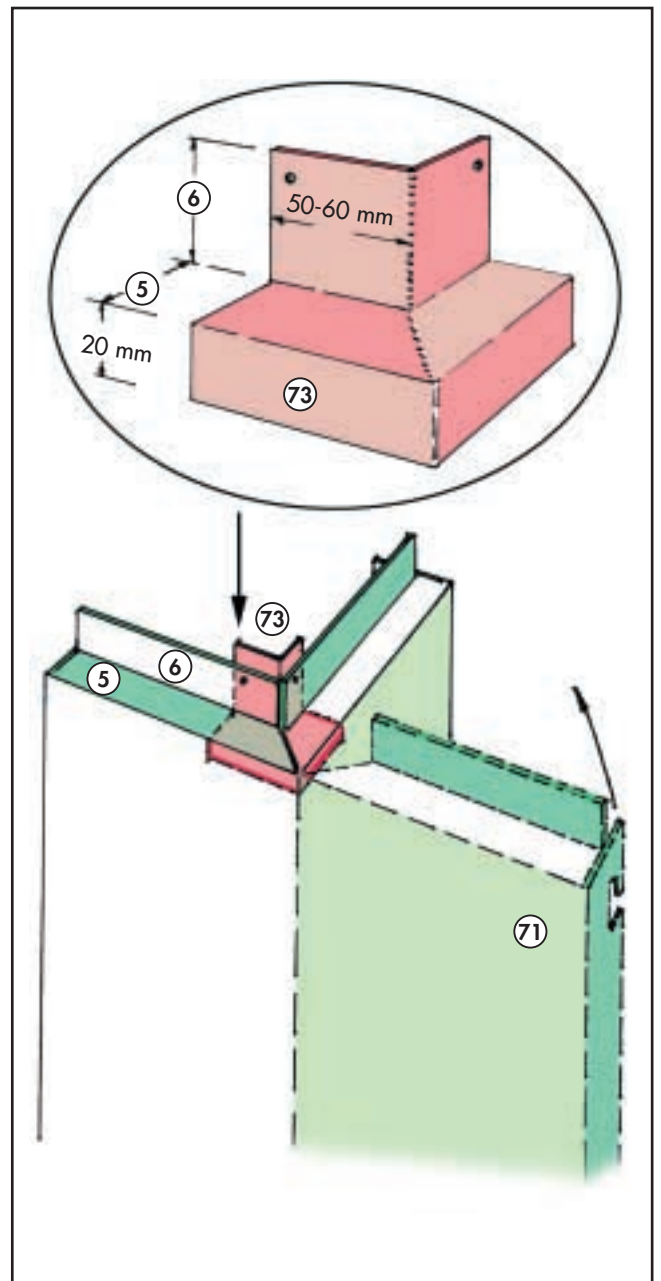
Prospetto dell'estremità superiore dell'angolo sporgente, con chiusura superiore (73) fissata con viti
